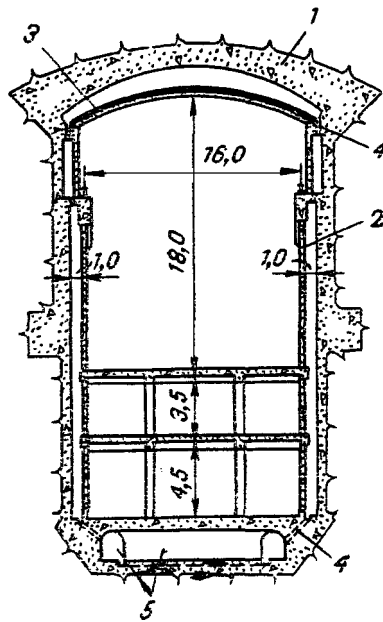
Дренаж и гидроизоляция подземного помещения:
